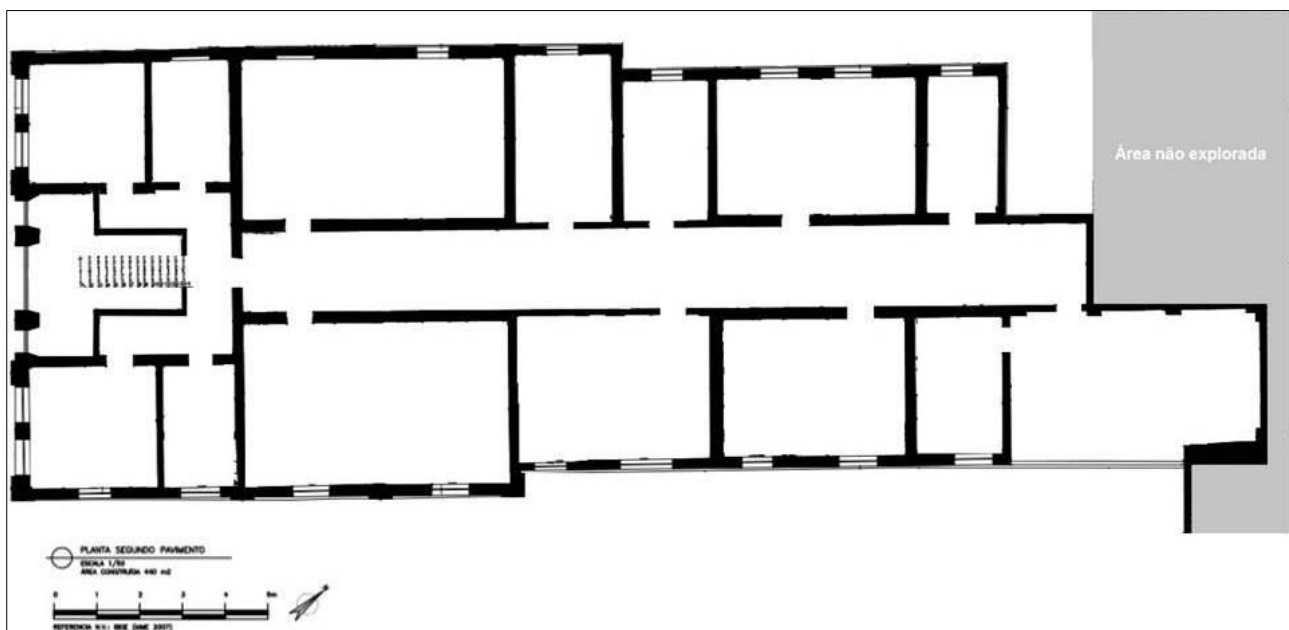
Planta baixa nº 2: segundo pavimento, momento anterior à implantação do HNPI.
